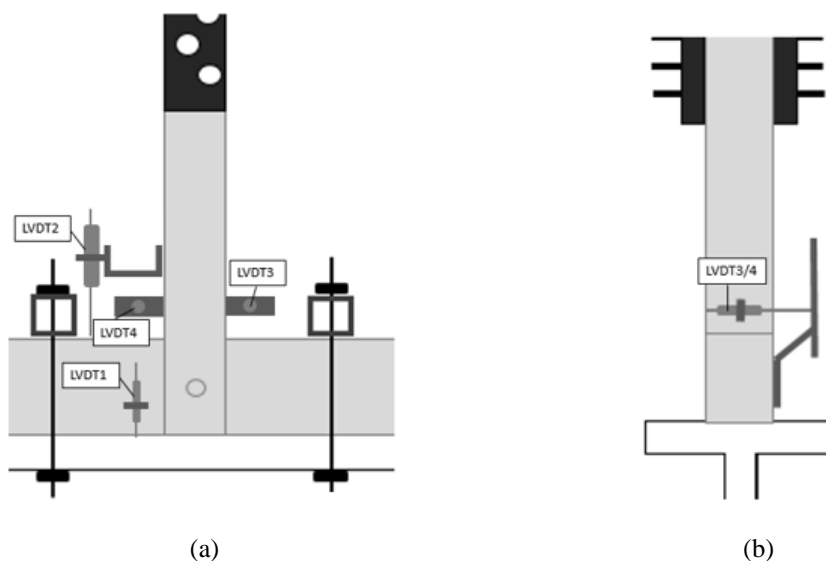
Pormenor do *set-up* com os LVDT's: (a) Vista frontal; (b) Vista lateral.
